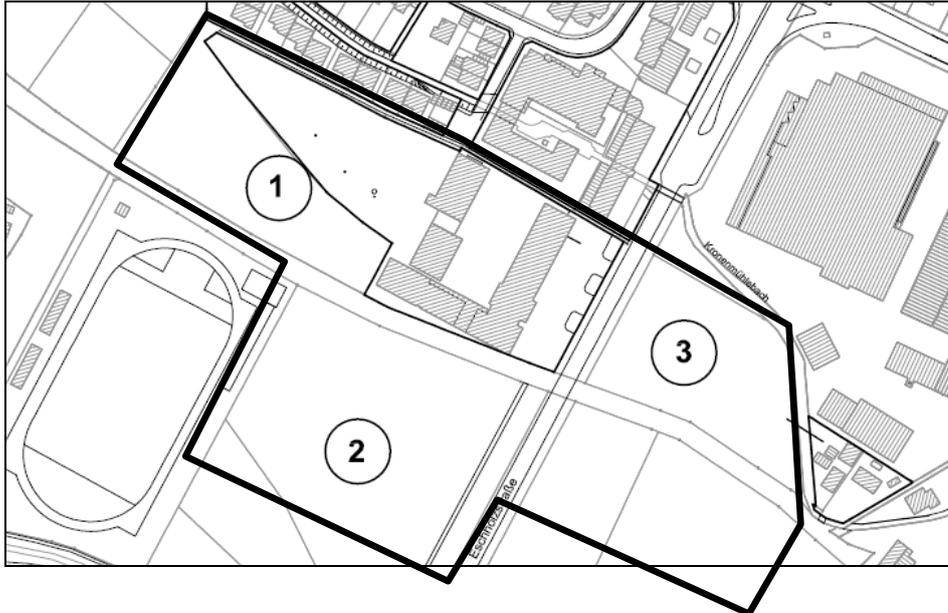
Drei Varianten zur Erweiterung zum Rettungszentrum am Standort Eschholzstraße 118.
